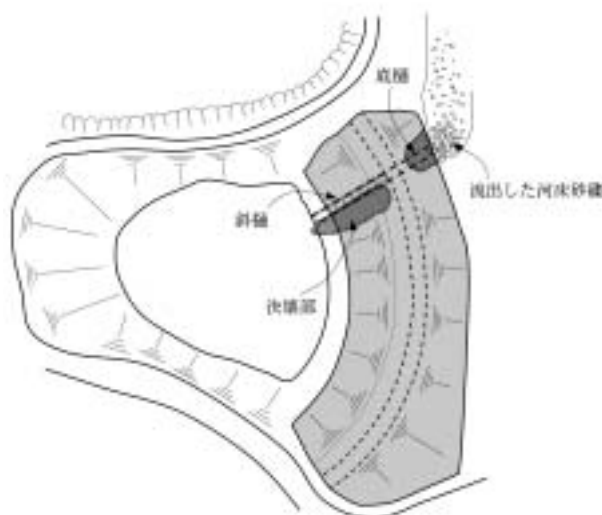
宝谷ため池平面図 Plan of Takaratani dam
